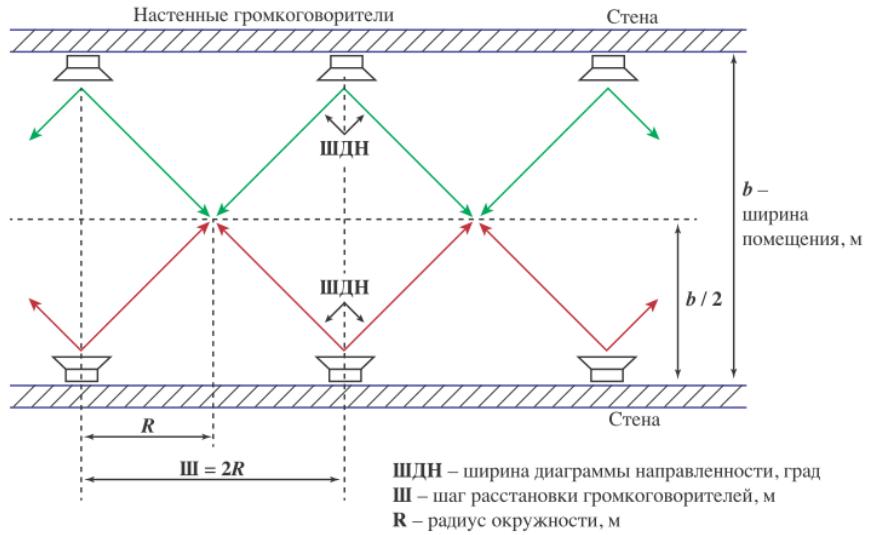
Расстановка настенных громкоговорителей вдоль стен в объемном прямоугольном помещении (во встречном порядке).
